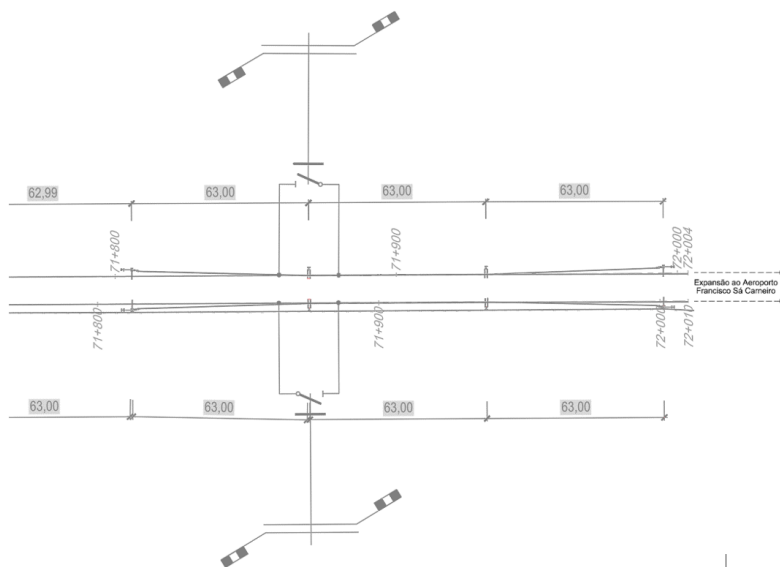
SLA para a separação elétrica com a futura expansão para o aeroporto
